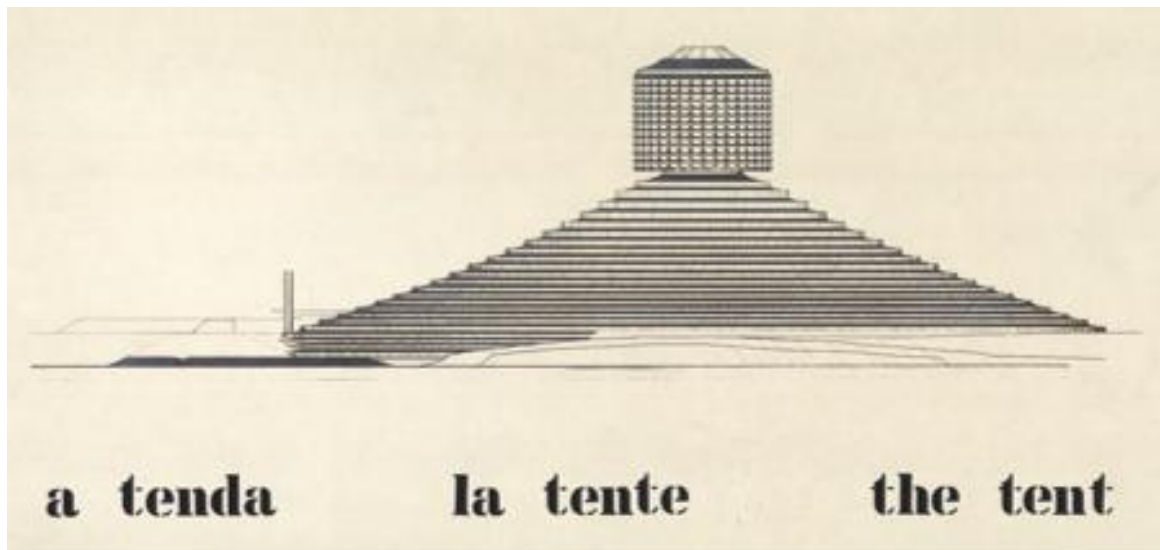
Croquis Sergio Bernardes – estudos estruturais: Hotel Tropical de Manaus – versão intermediária.
